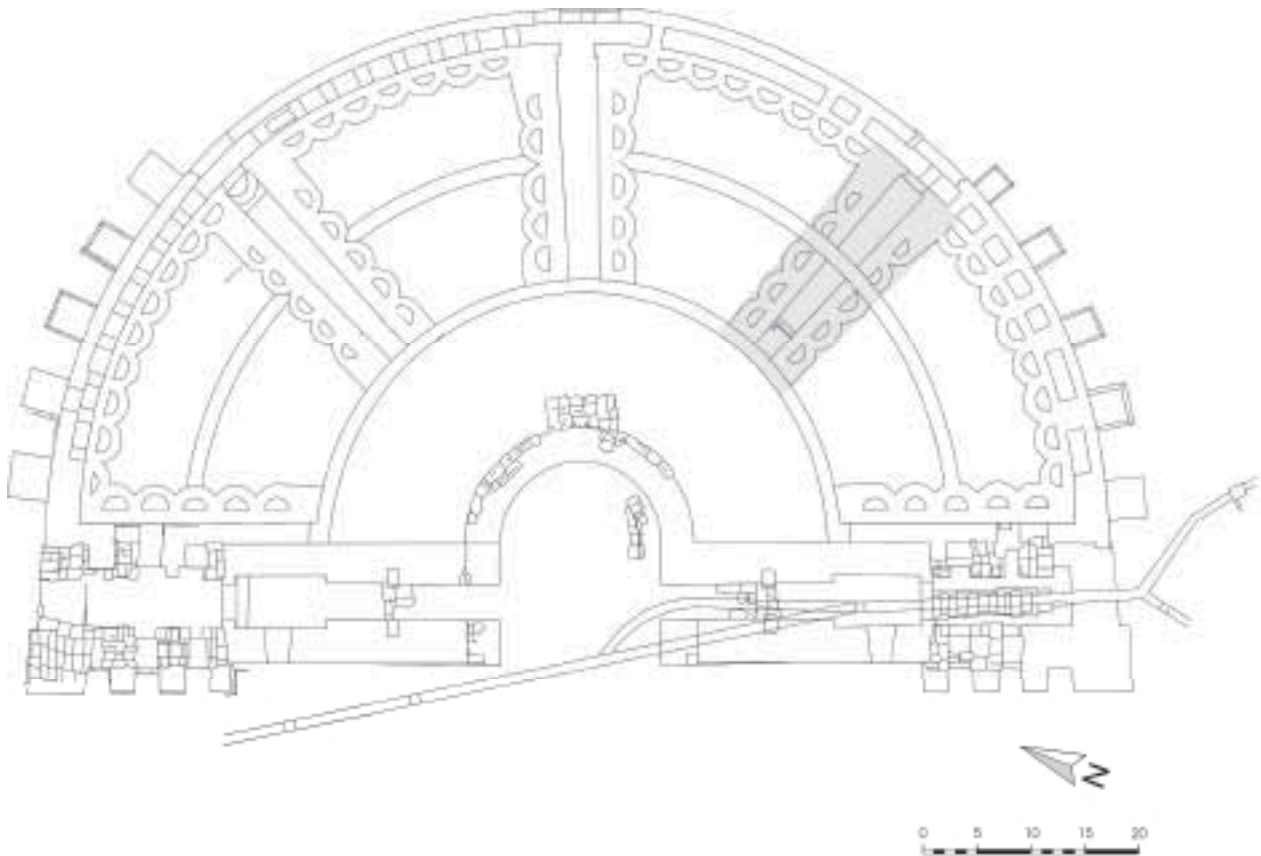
Augst, Theater. Grundrissplan (jüngste Bauphase) mit Lage des Südost-Vomitoriums (hellgrau). M. ca. 1:700.
